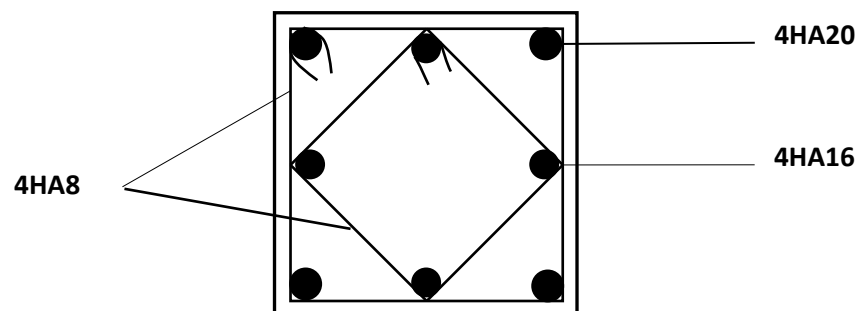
Schéma de ferrailage du poteau Sous-sol.RDC 1^{er} étage
